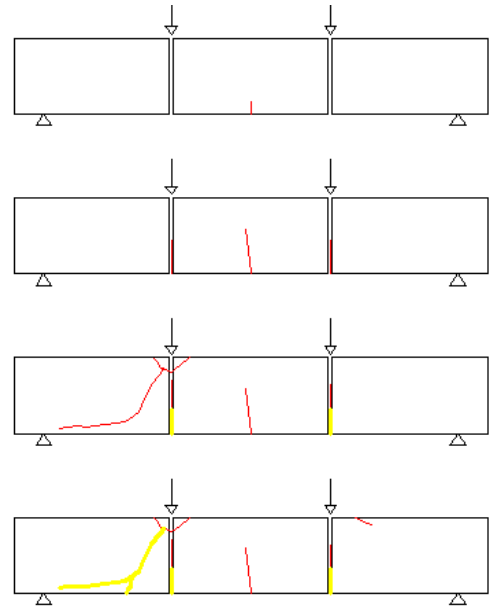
Mapeamento das fissuras VCE+1.
